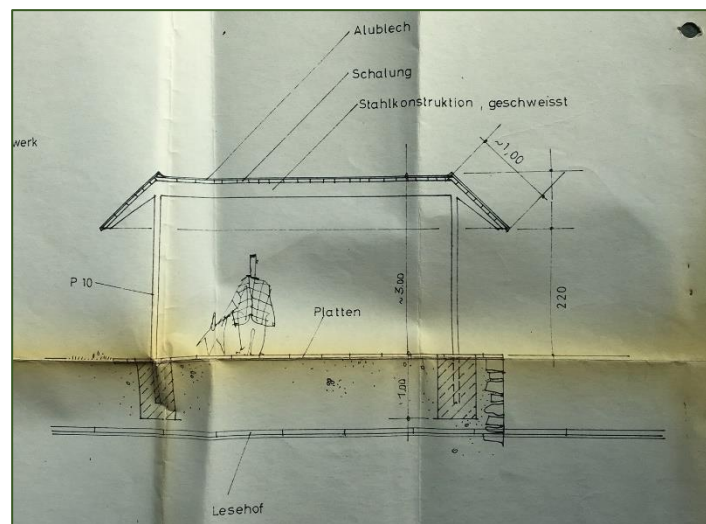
Pavillon Gebäudeschnitt, Entwurf Hochbauamt Mainz 05.04.1961; Ausschnitt
